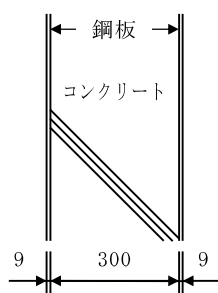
遮蔽扉の概要 (SSD-4) (単位 : mm)
